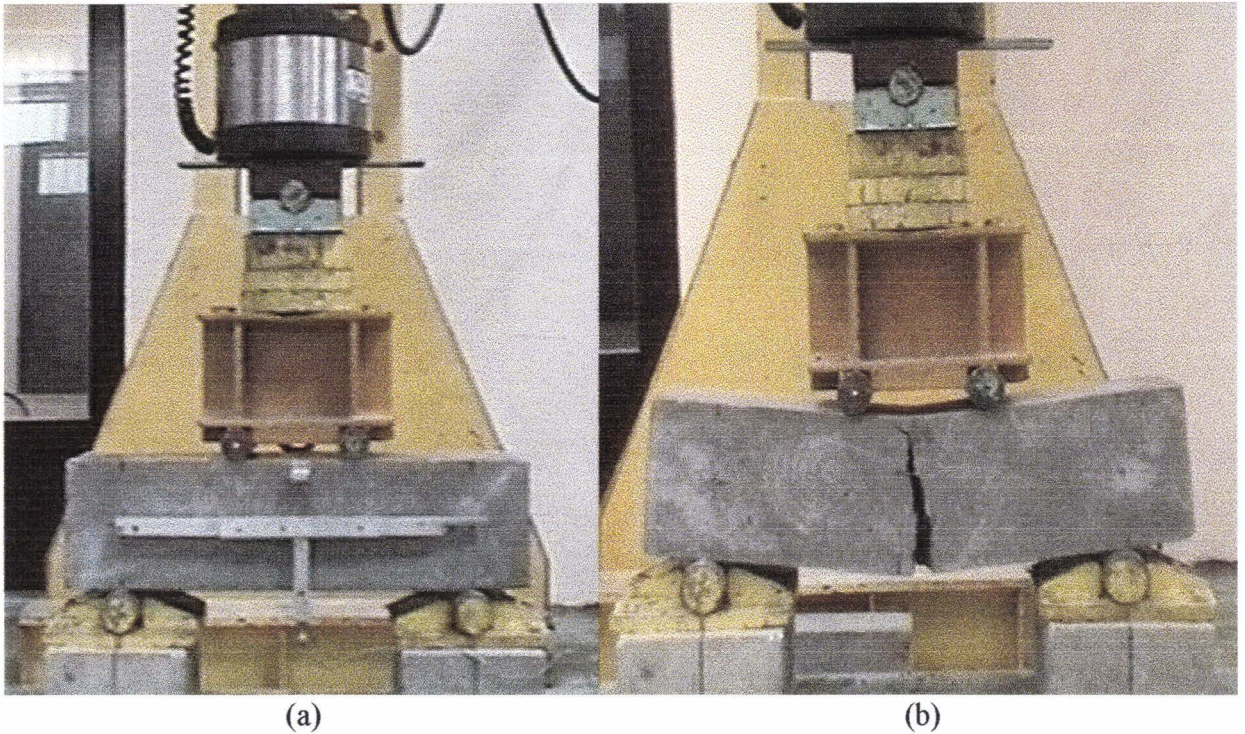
Asservissement de l'essai de flexion sur les prismes 15×15×60 cm (a) montage expérimental (b) localisation de la fissure
